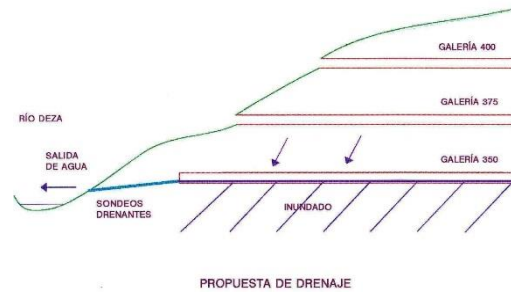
Esquema de drenaje de la galería 375 mediante sondeos desde el río Deza a la galería 350
